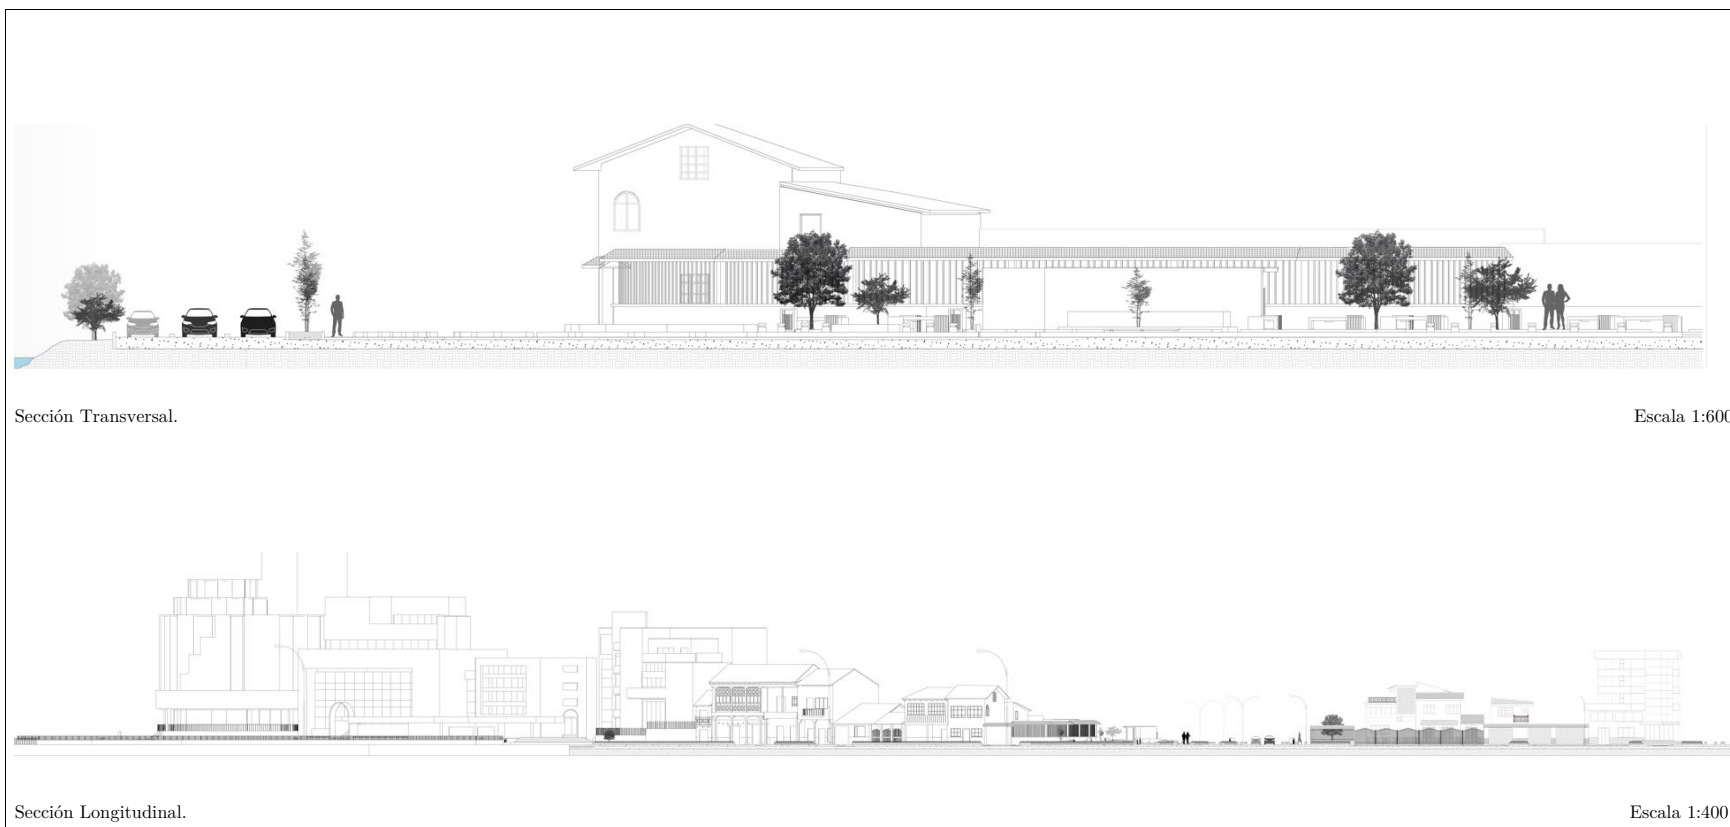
Sección Transversal y longitudinal. Fuente y elaboración: Autoras.
